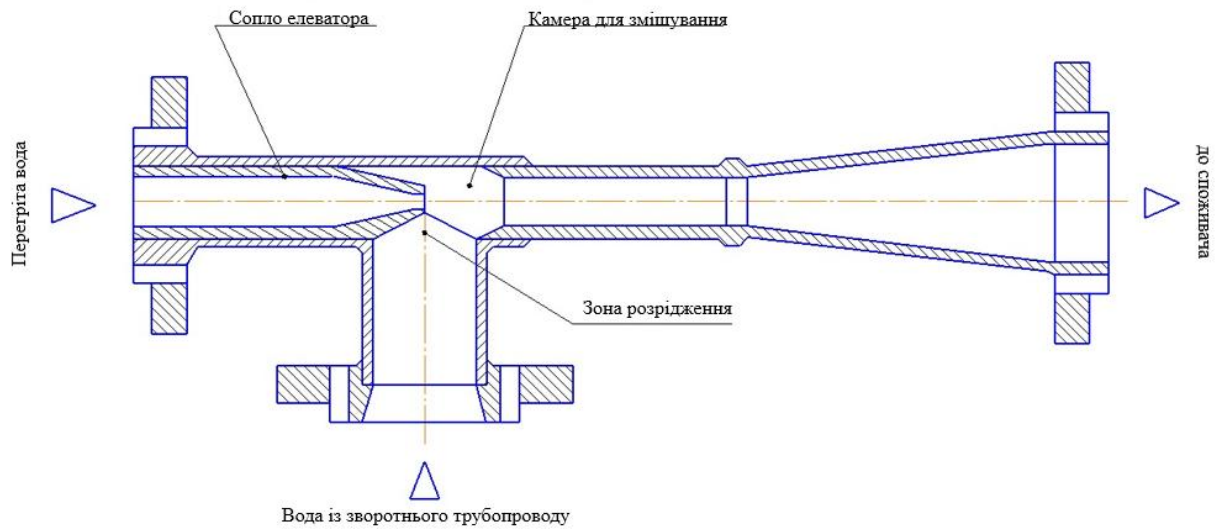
Принципова схема конструкції елеваторного вузла
